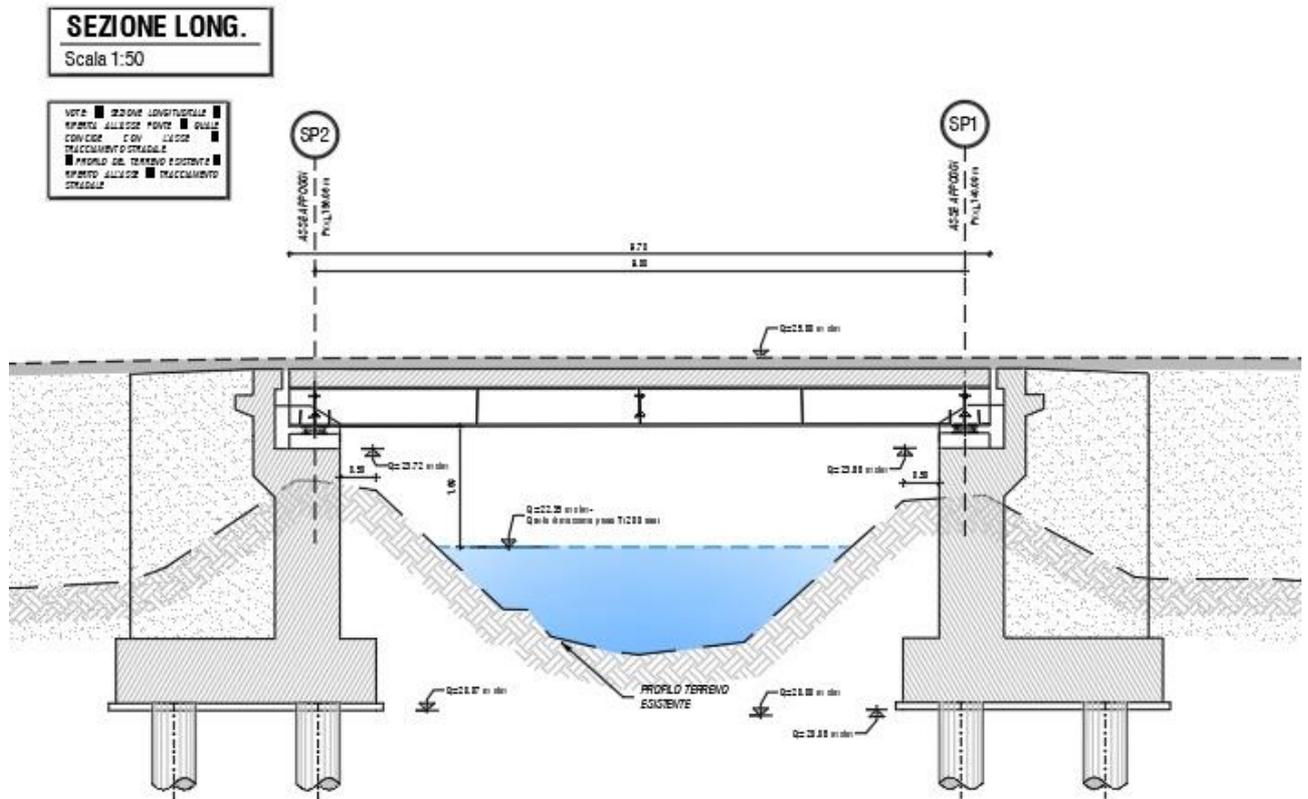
Sezione longitudinale Ponte 02- su Canal Magro Via delle Gorine
